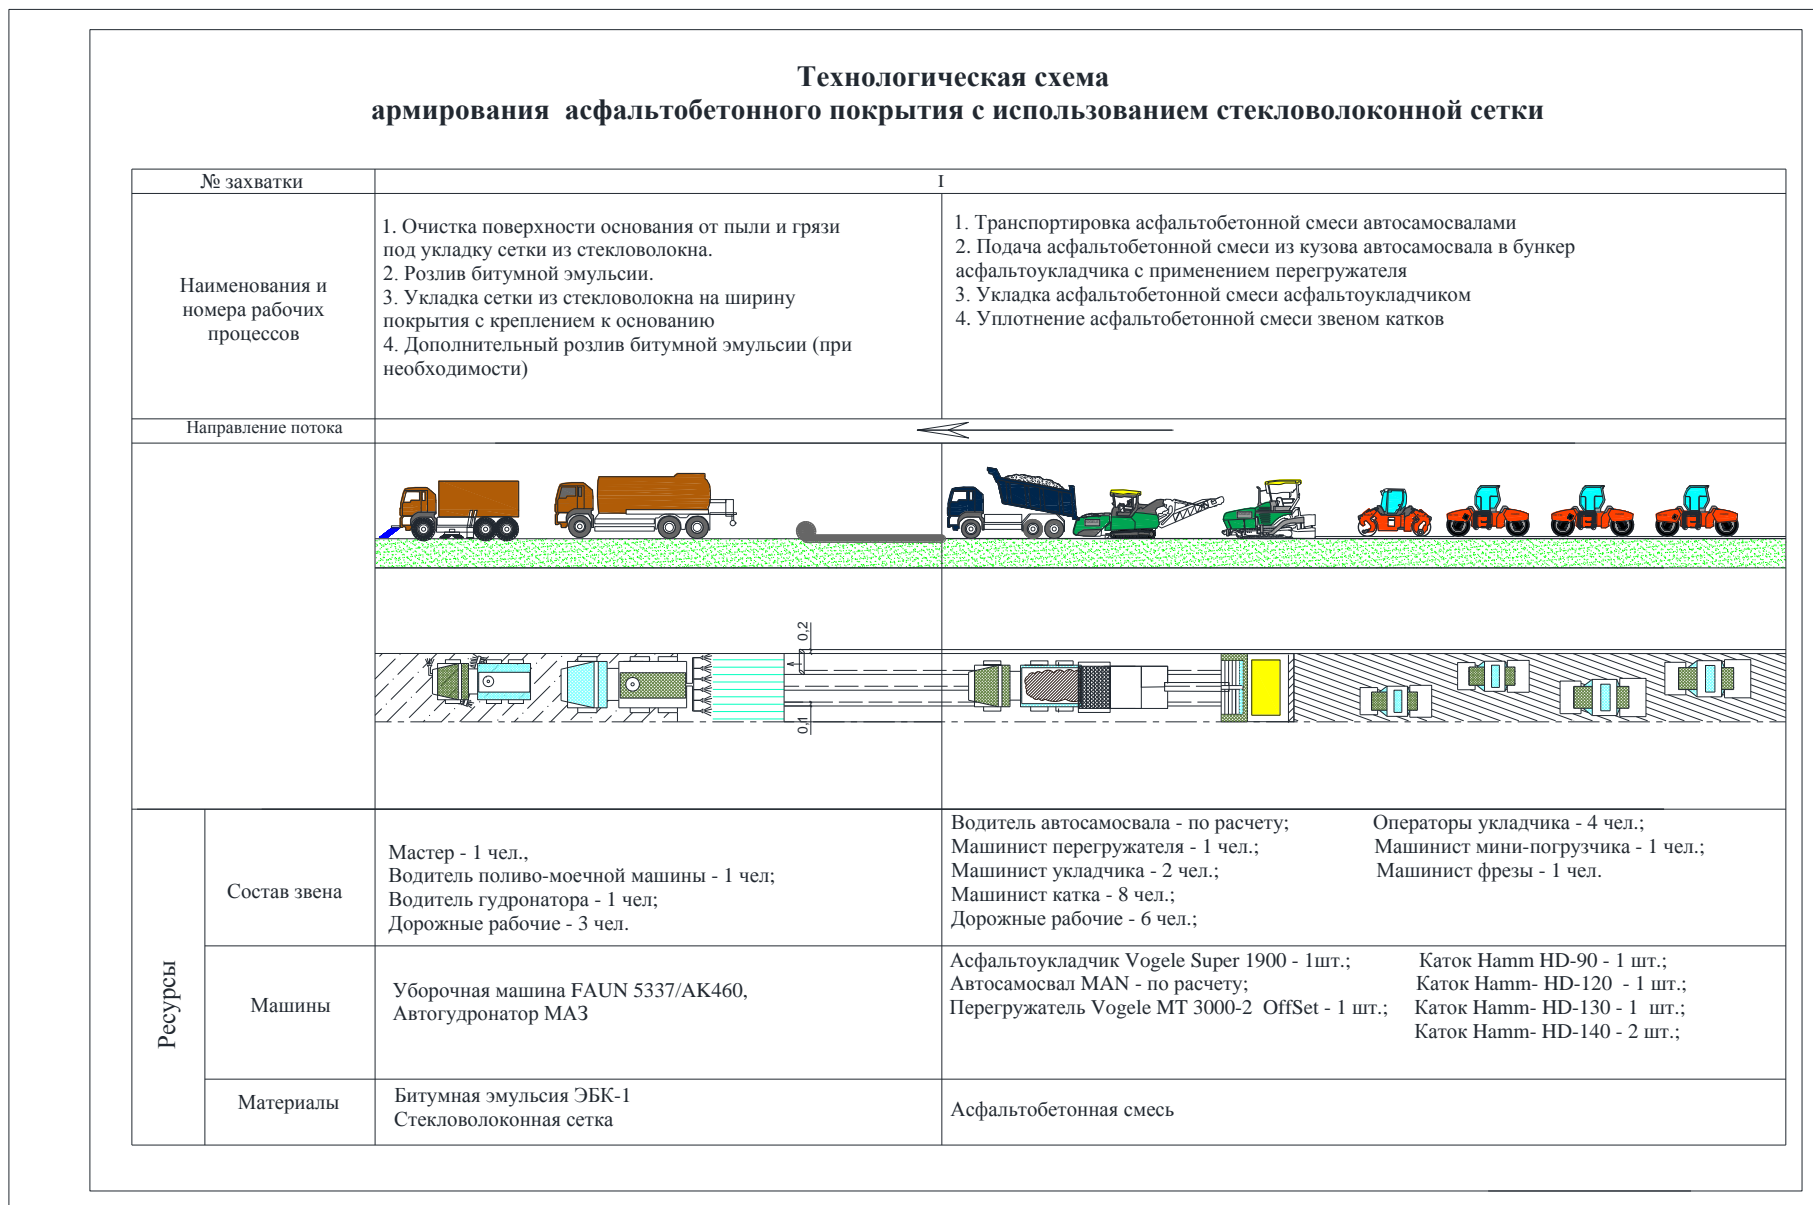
Технологическая схема армирования асфальтобетонного покрытия стекловолоконной сеткой
